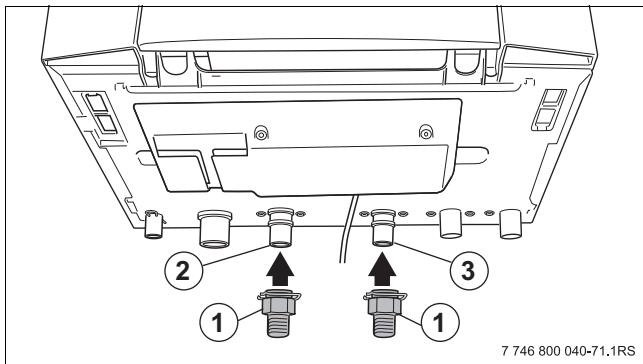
Rohrleitungen für externen Warmwasserspeicher montieren
